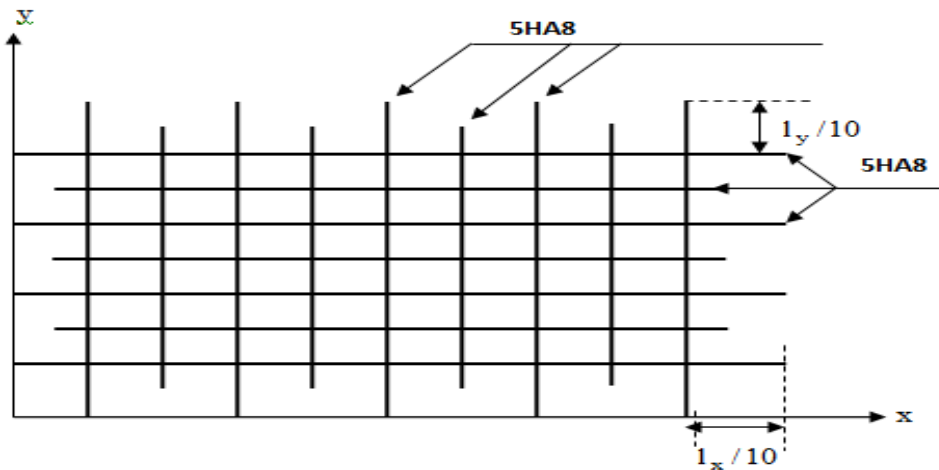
Schéma de ferrailage de la dalle de l'ascenseur
